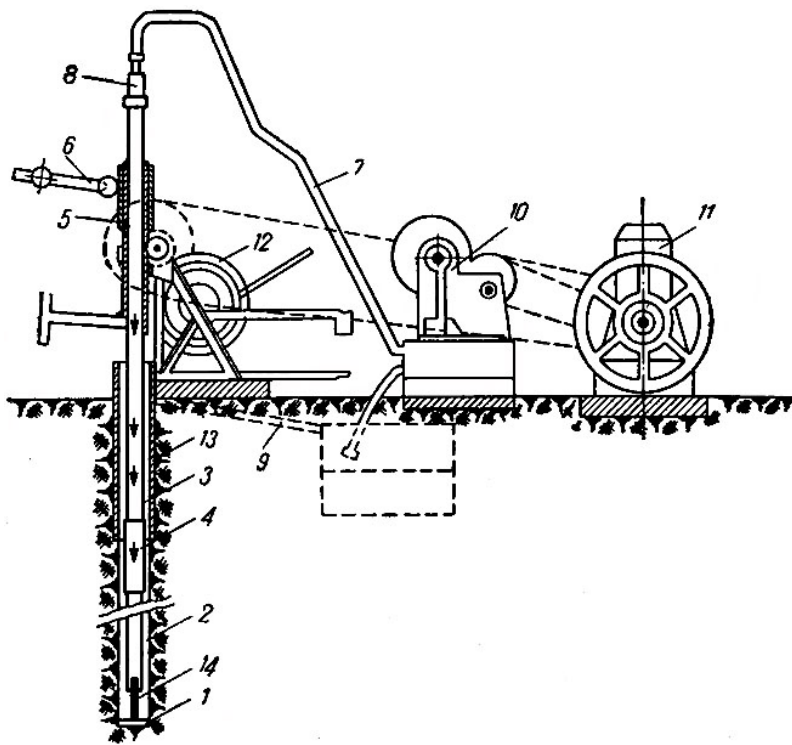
Схема установки колонкового бурения: 1 – резец; 2 – колонковая труба; 3 – трубчатая штанга; 4 – переводник; 5 – шпindelь; 6 – рычажное устройство для регулирования нагрузки на забой; 7 – шланг для подачи в скважину глинистого раствора; 8 – верх шланги; 9 – желоб для осаждения промывочного раствора; 10 – насос; 11 – двигатель; 12 – лебедка для подъема оборудования из скважины; 13 – шламовая труба; 14 – керн
